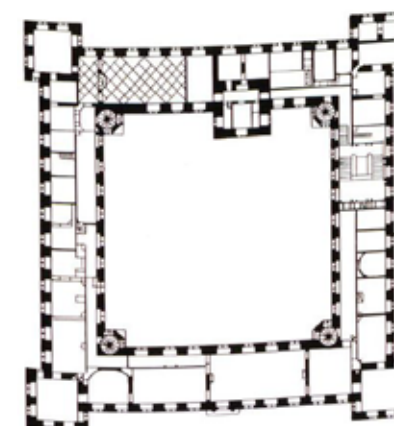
Grundriss der Aschaffenburg (Ullmann 1995, S.95)
